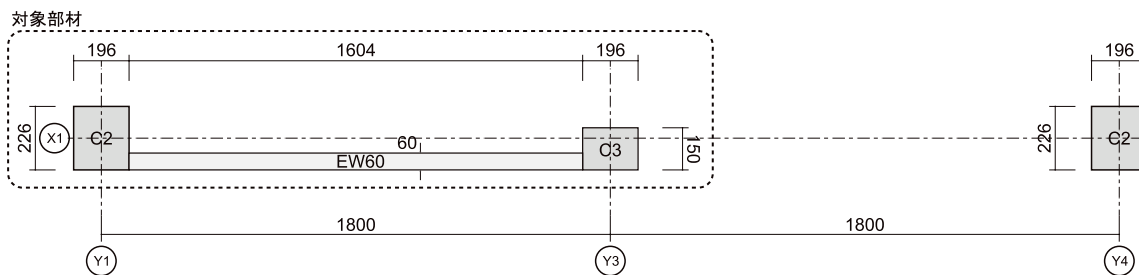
構面 1 階断面図 (単位 : mm) A1.4)
